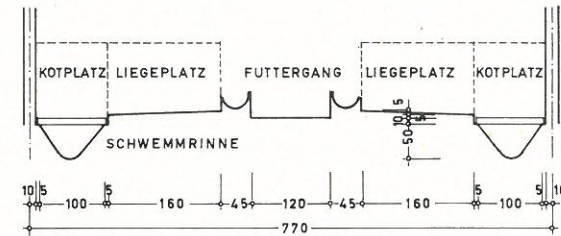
Mastschweinestall mit dänischer Aufstallung. Spaltenboden über Schwemmrinne.
